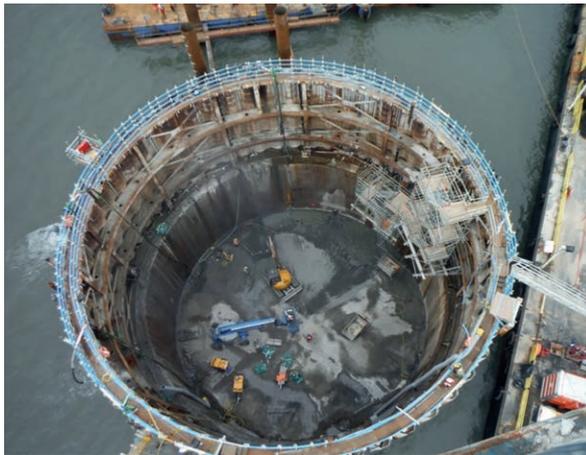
Cajón de la Torre Norte con el tapón de hormigón sumergido ejecutado y tras el vaciado de agua en el interior.
